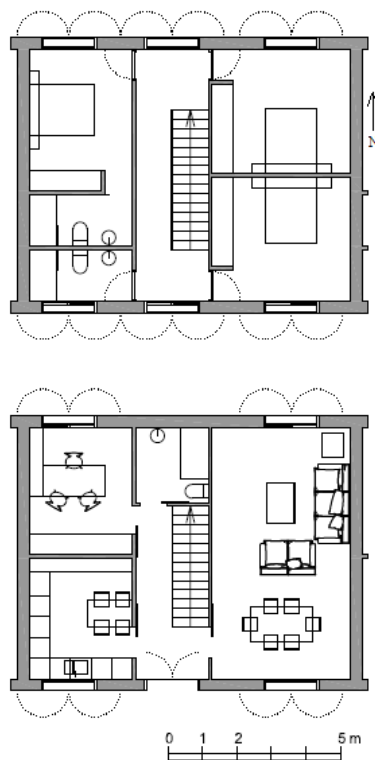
Planos de planta de la vivienda entre medianeras.
